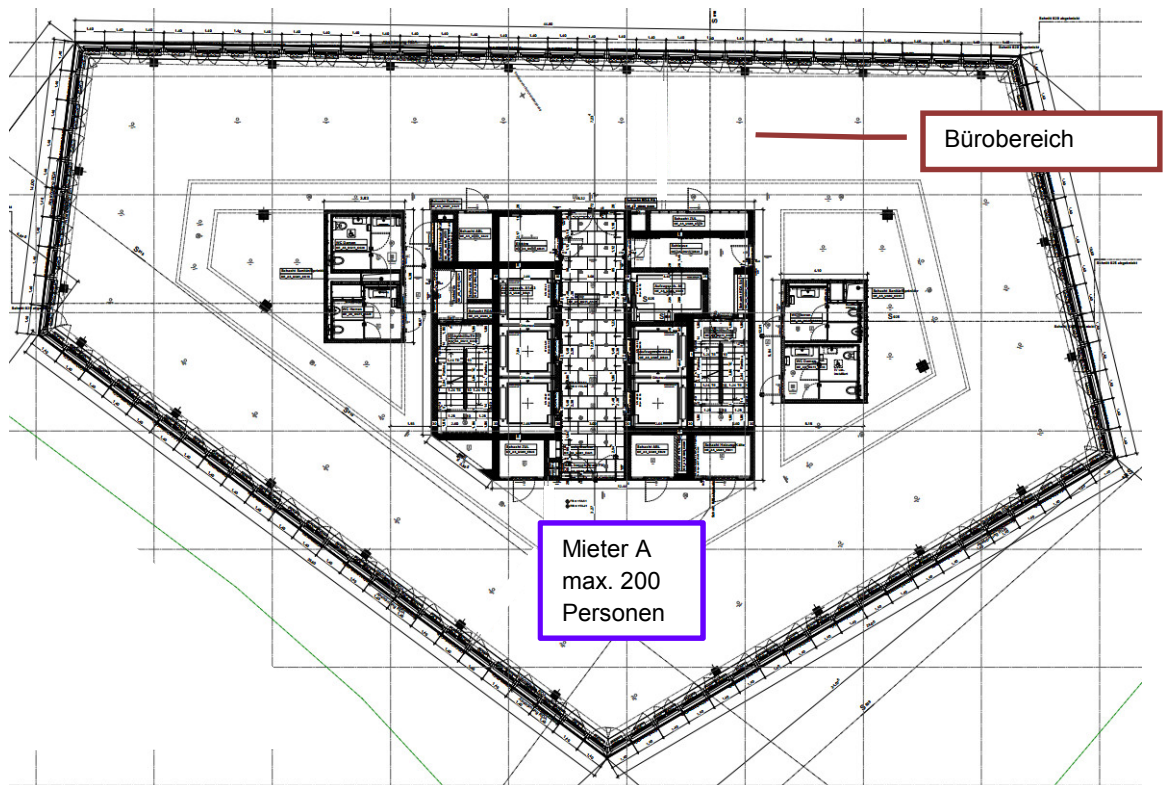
Grundriss Regelgeschoss von Hochhaus ohne Unterteilung
